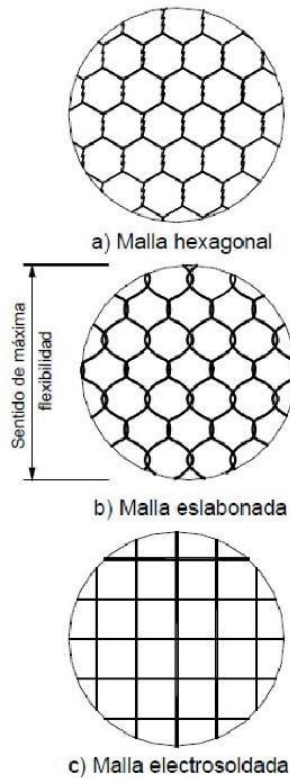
Tipos de mallas utilizadas en la construcción de gaviones. Fuente: (Suárez Díaz, 2001).
